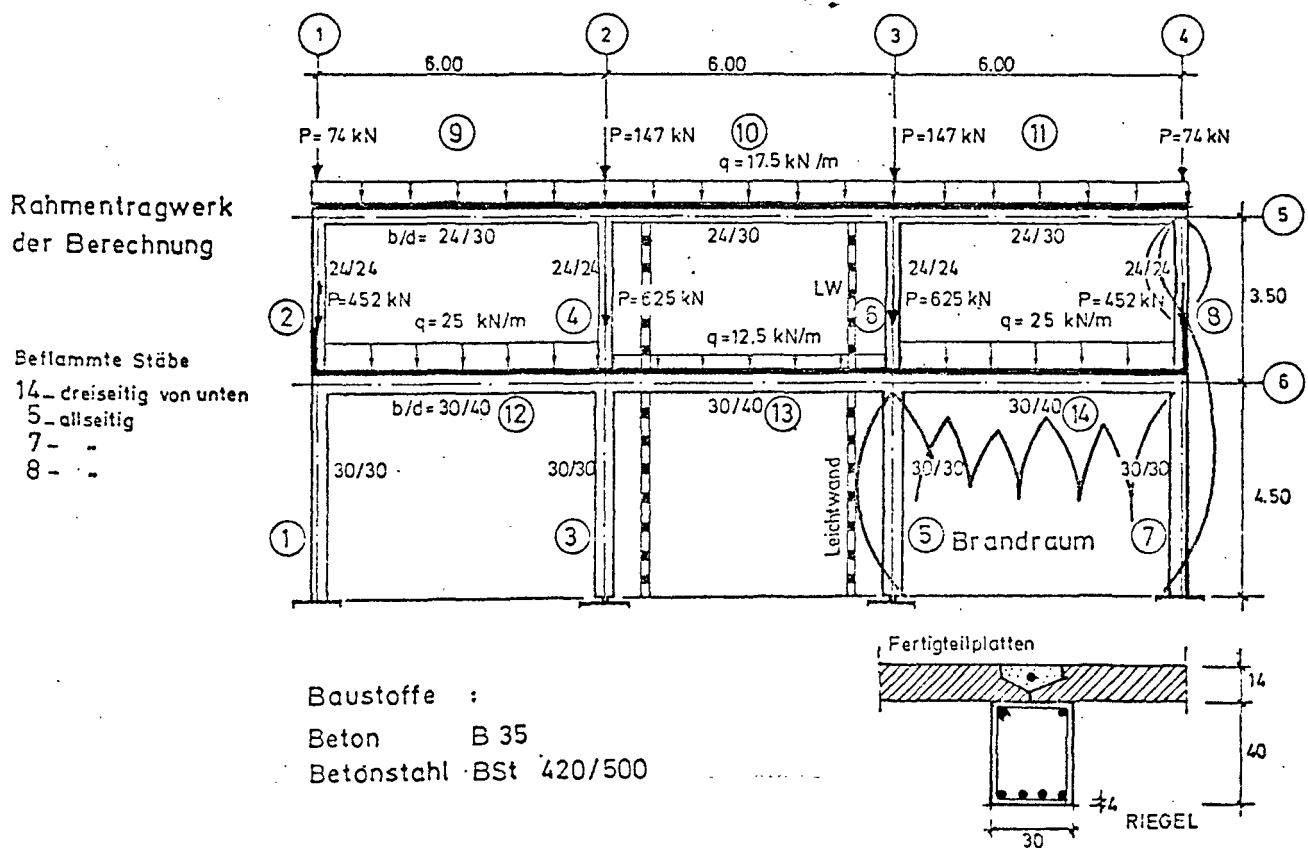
Geometrie des untersuchten Stahlbetonrahmens
